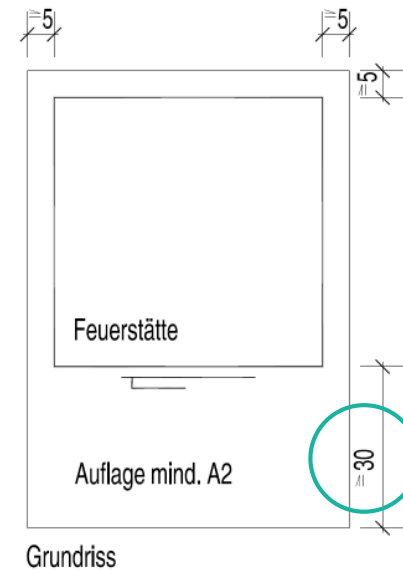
Fußbodenauflage mind. A2 auf Fußbodenkonstruktion mit brennbaren Baustoffen
